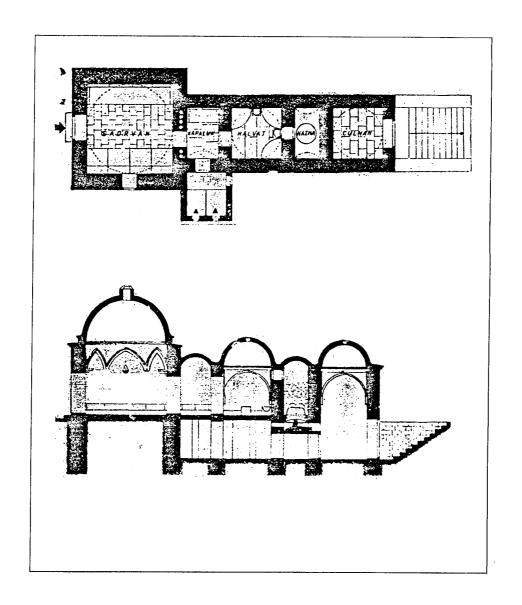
مسقط أفقي وقطاع لحمام غازي خسرو بك في سراييفو (عن :Pašić) .
